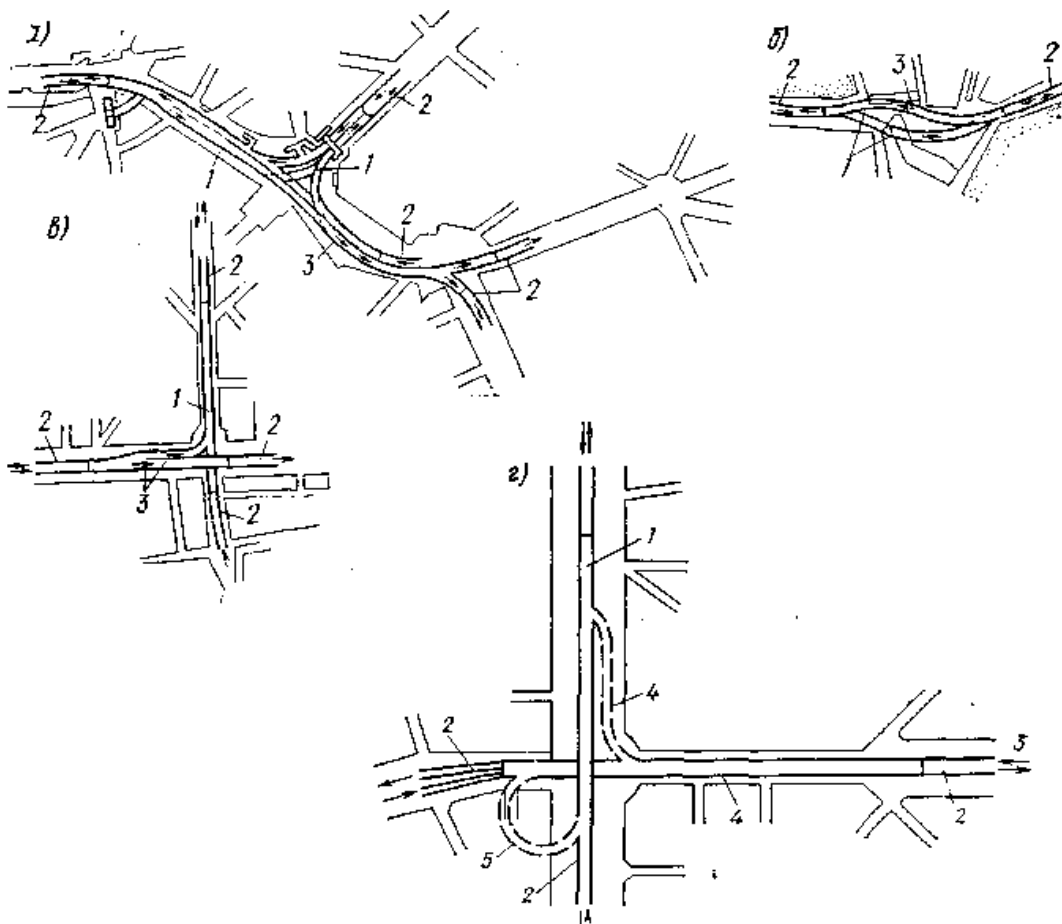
Планировочные схемы разветвляющихся (а, б) и пересекающихся в плане (в, г) транспортных тоннелей:
